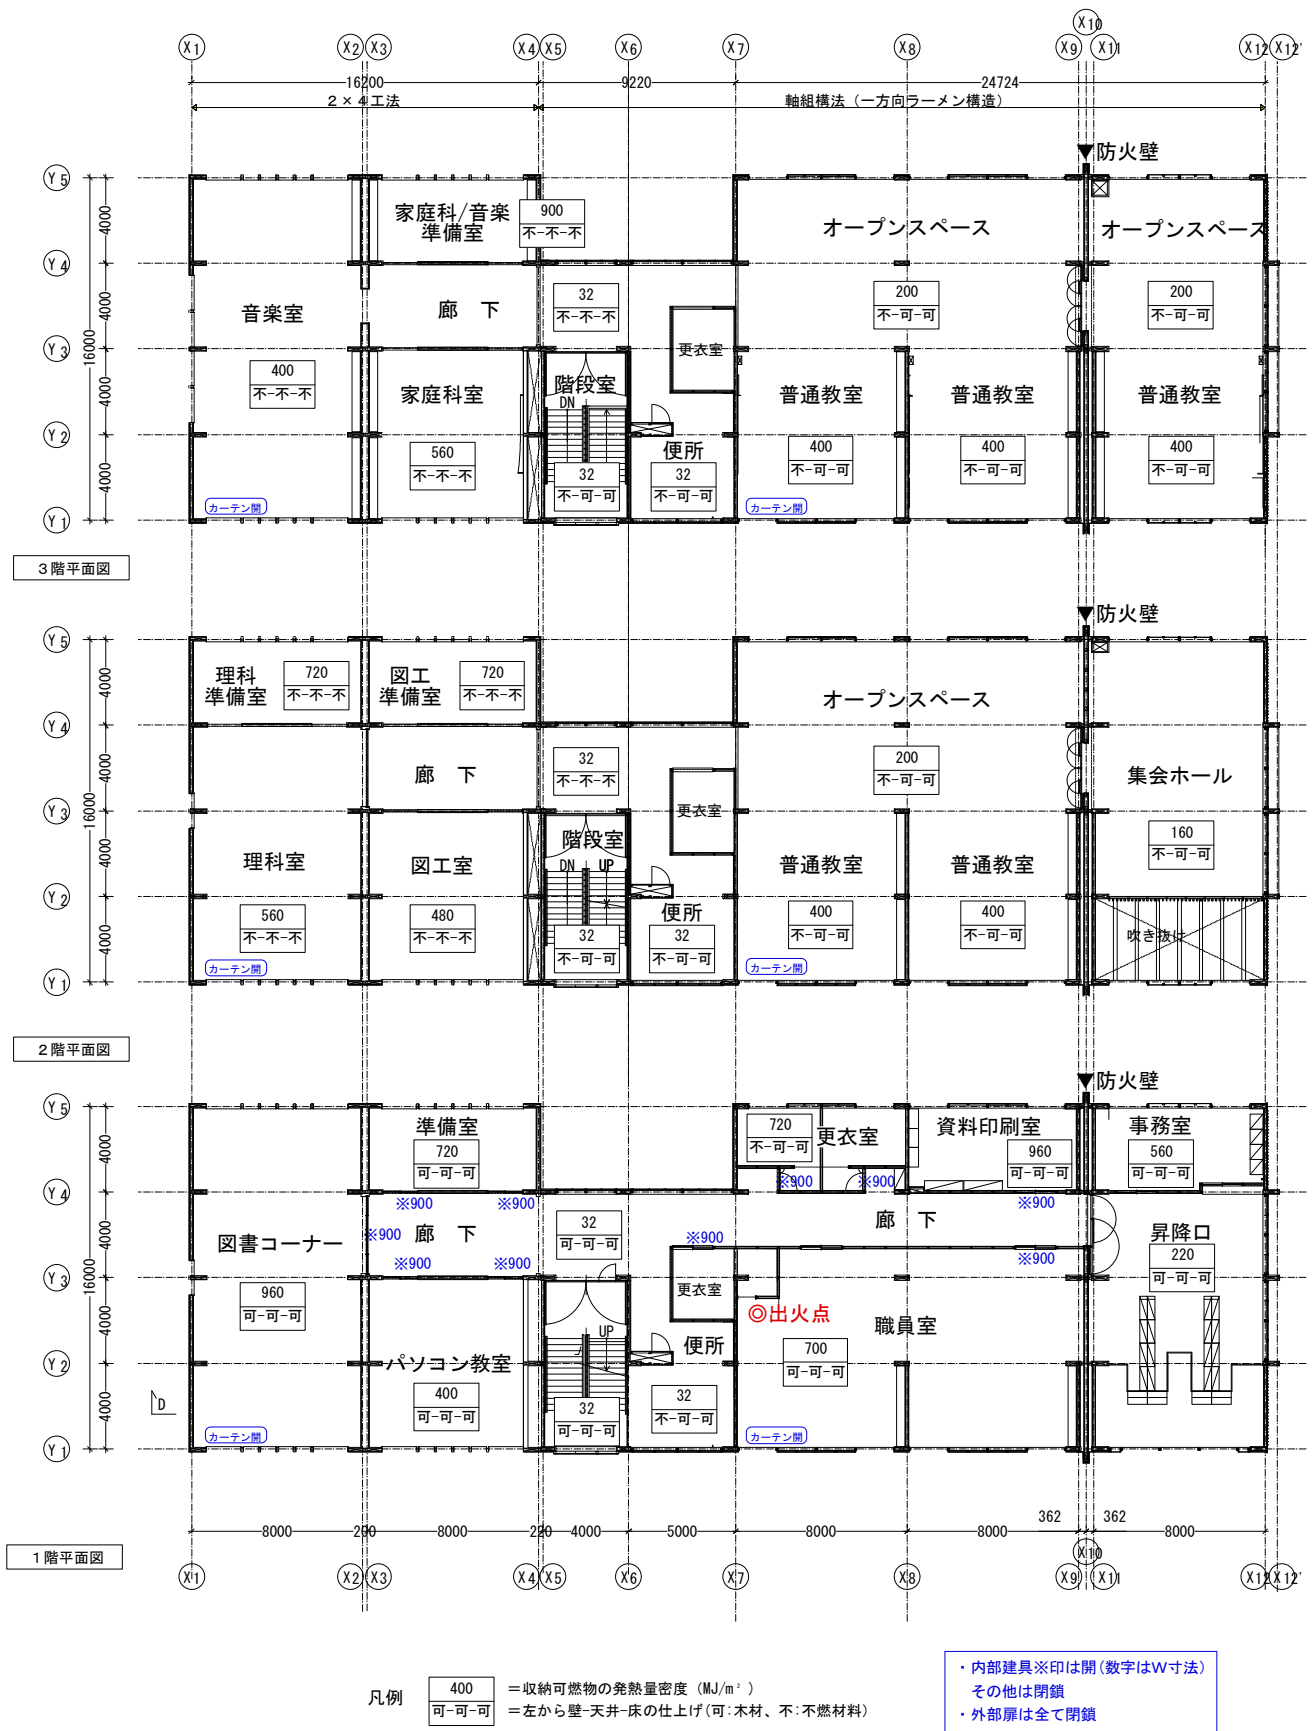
平面図および開口・収納可燃物等条件 (予備実験)
